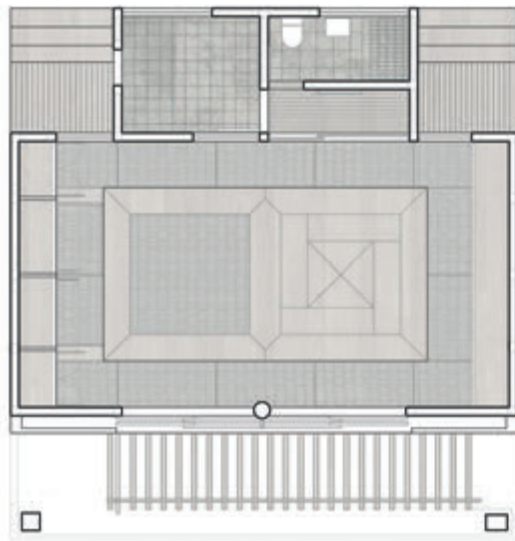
Planta baja y altillo de la vivienda. Figura de autor.
